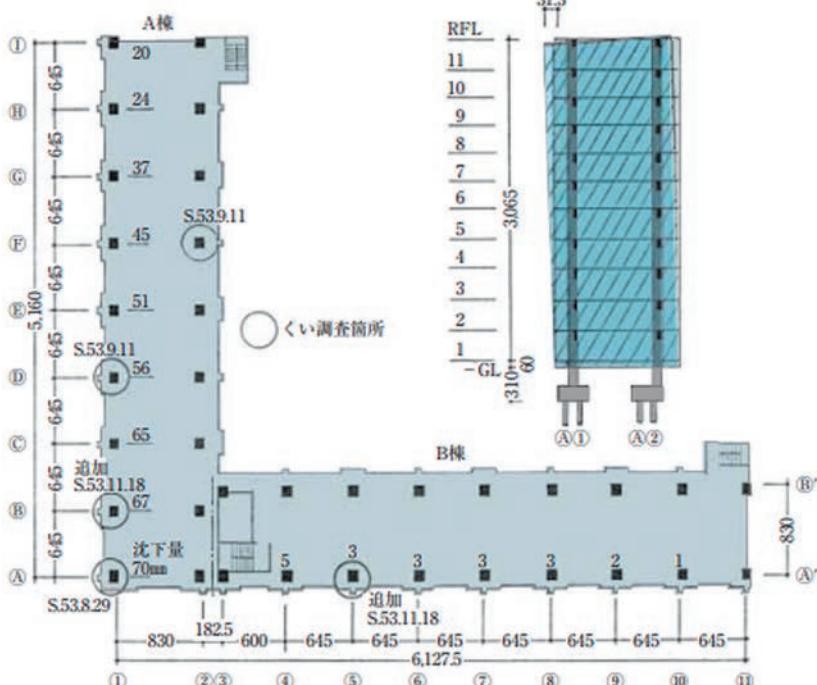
傾いた11階建てマンションの平面図 左が傾いたA棟、右がB棟
